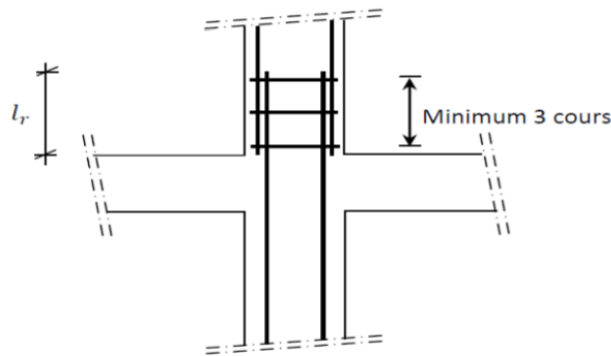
les armatures transversales dans la zone de recouvrement
